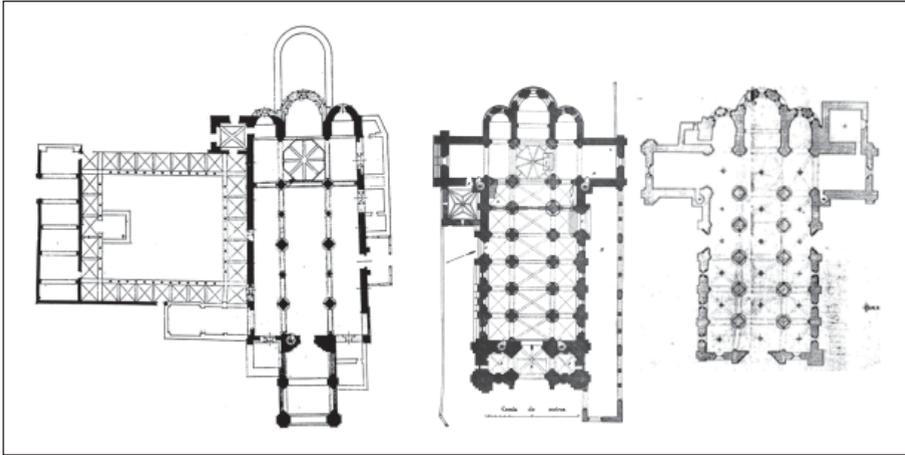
Planta de la catedral de Jaca (Huesca), planta de la basílica de San Vicente (Ávila) y planta de la iglesia de San Pedro (Ávila).
